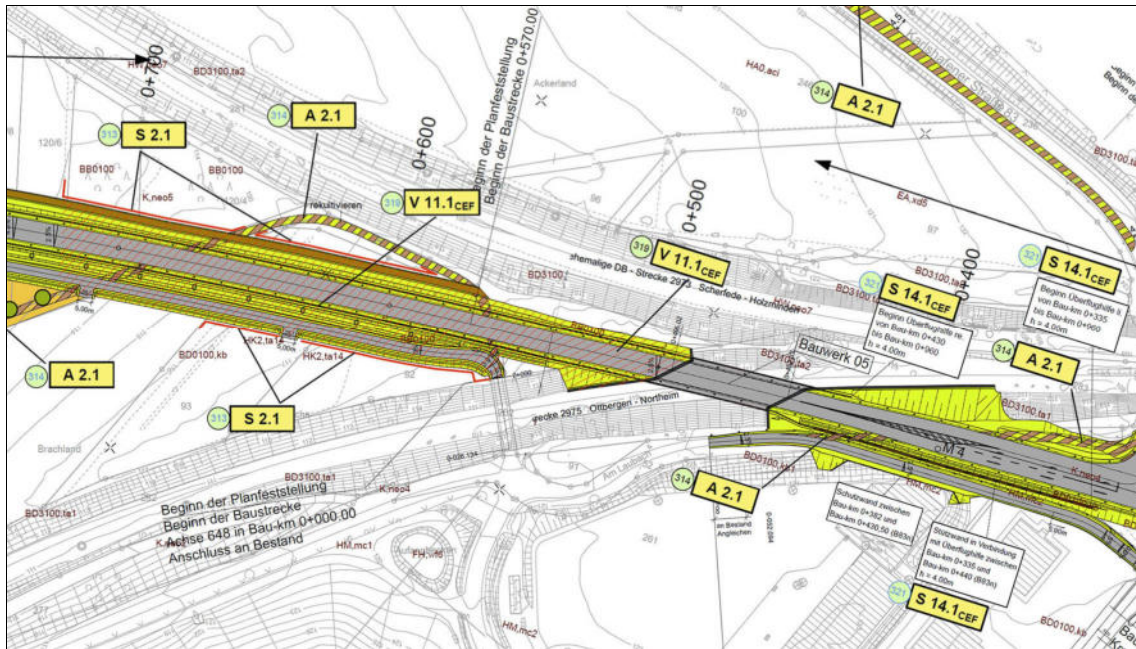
Ausschnitt aus dem Maßnahmenlageplan des LBP zu Struktur 1
